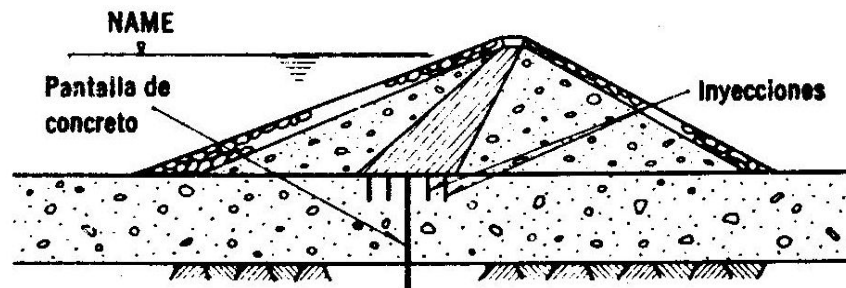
Pantalla de pilotes o muros de concreto simple
